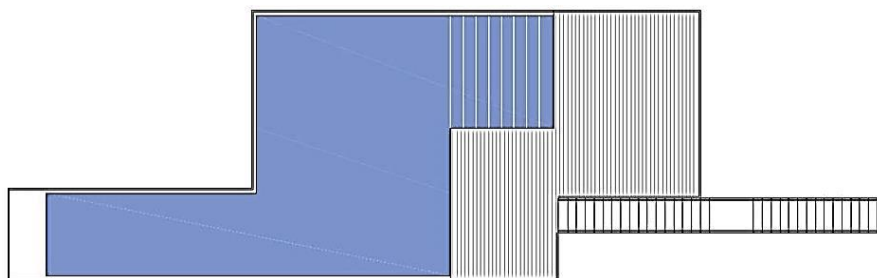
Modificações feitas pelo arquiteto 2 no terceiro pavimento (cobertura)
